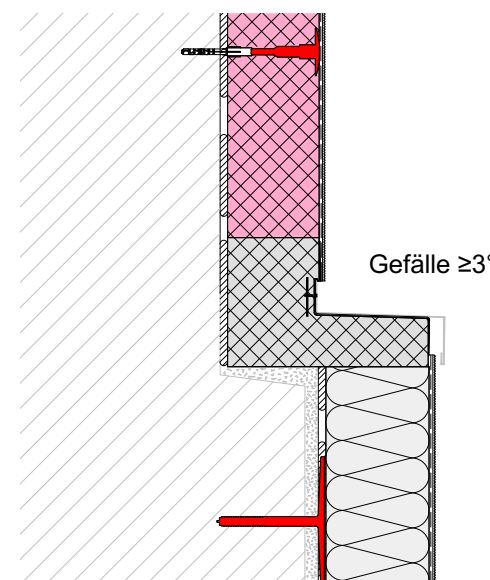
Ausführung mit Baumit SohlbankanschlussProfil
